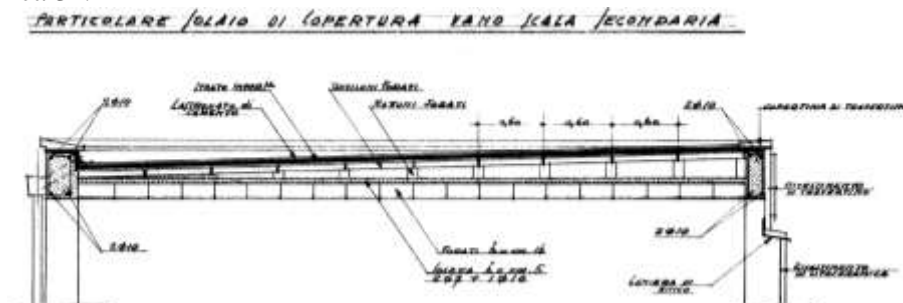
Solaio di copertura sub-orizzontale, da tavola storica.
